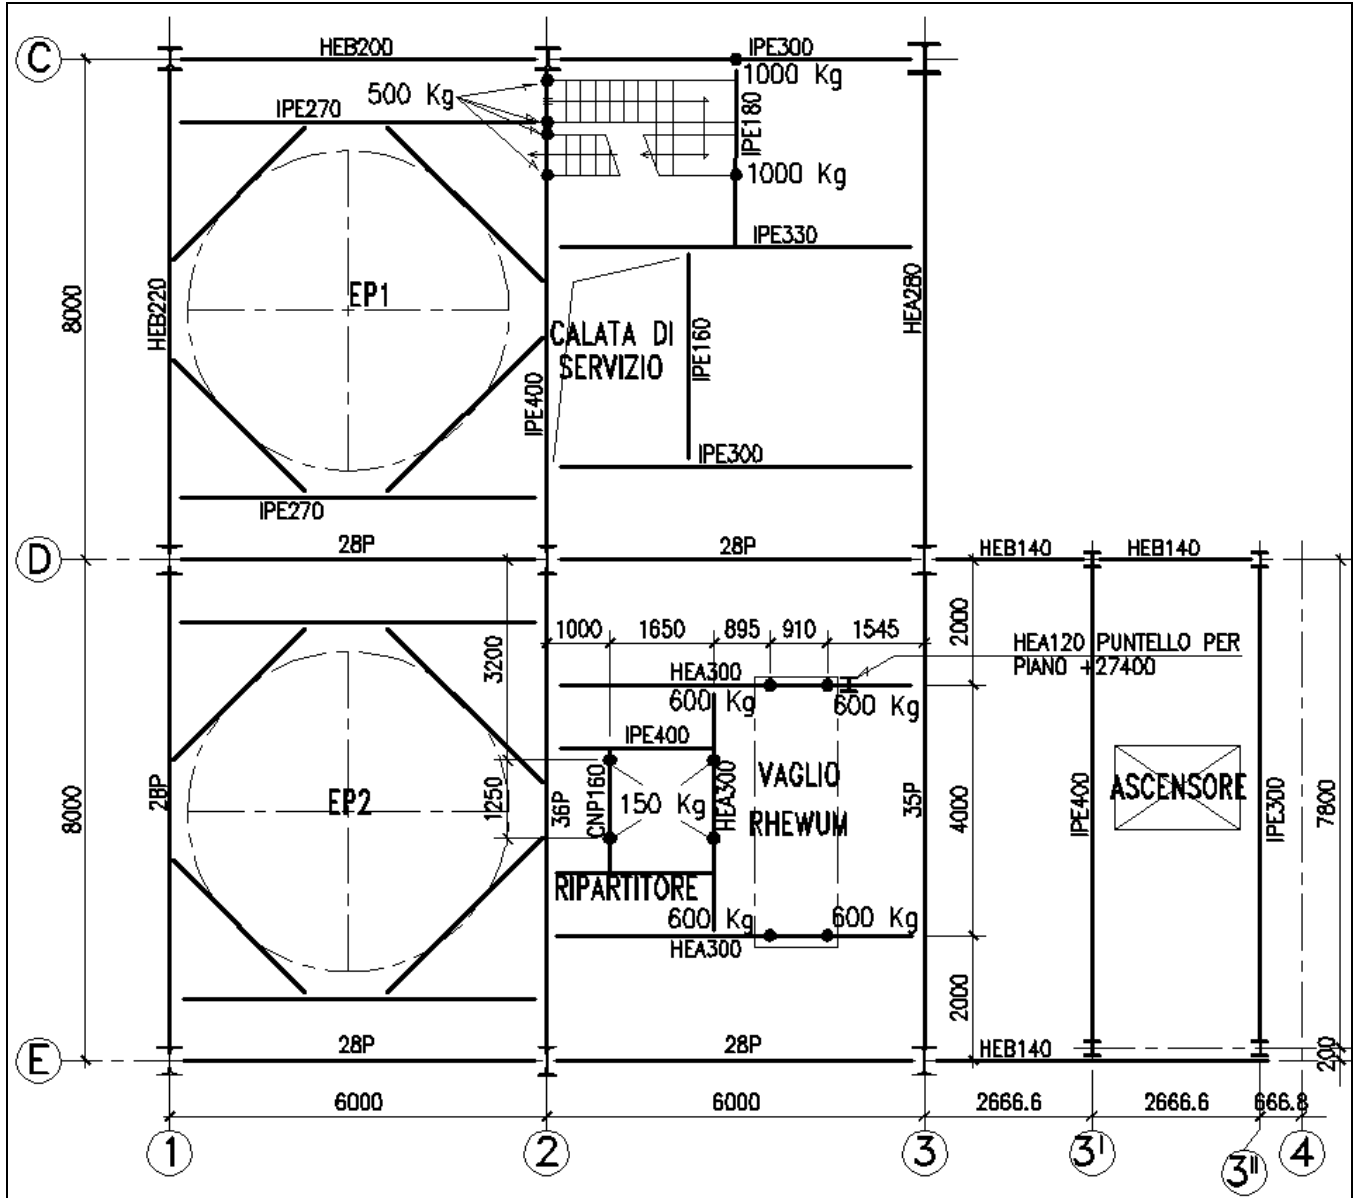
PLANIMETRIA +24.500 - quarto impalcato -
